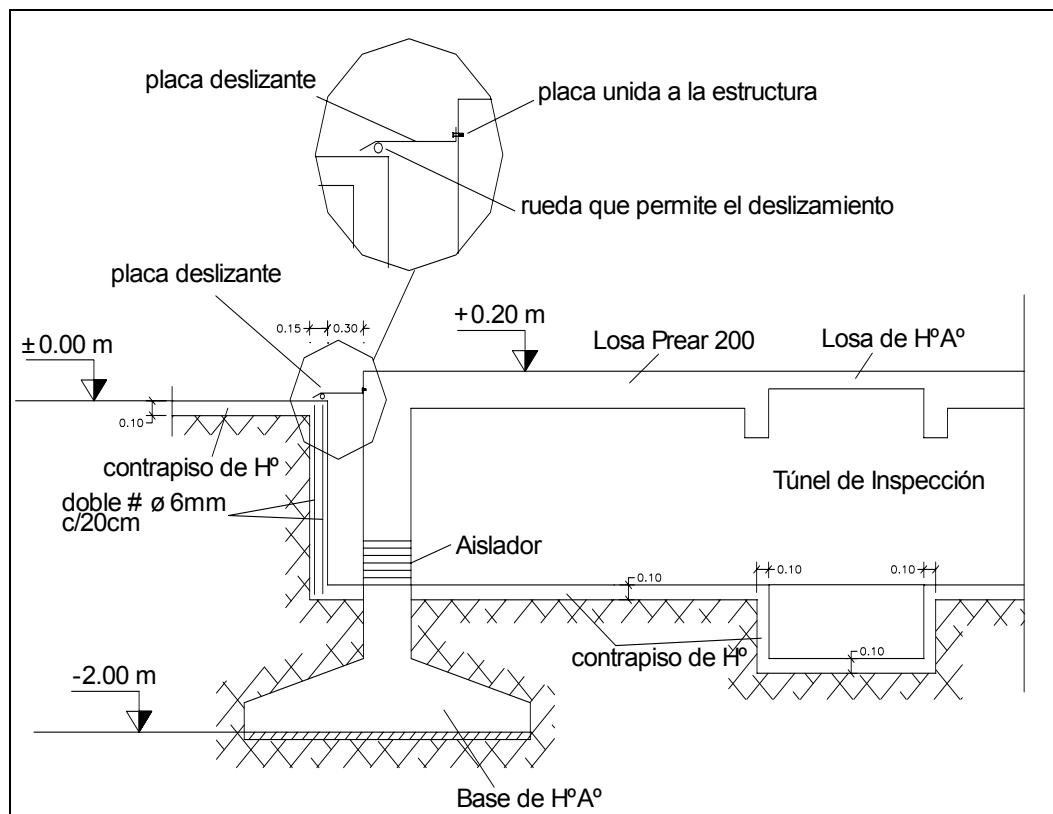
a: Esquema general de la disposición del sistema de aislamiento sísmico en la torre 3 (Corte transversal).
